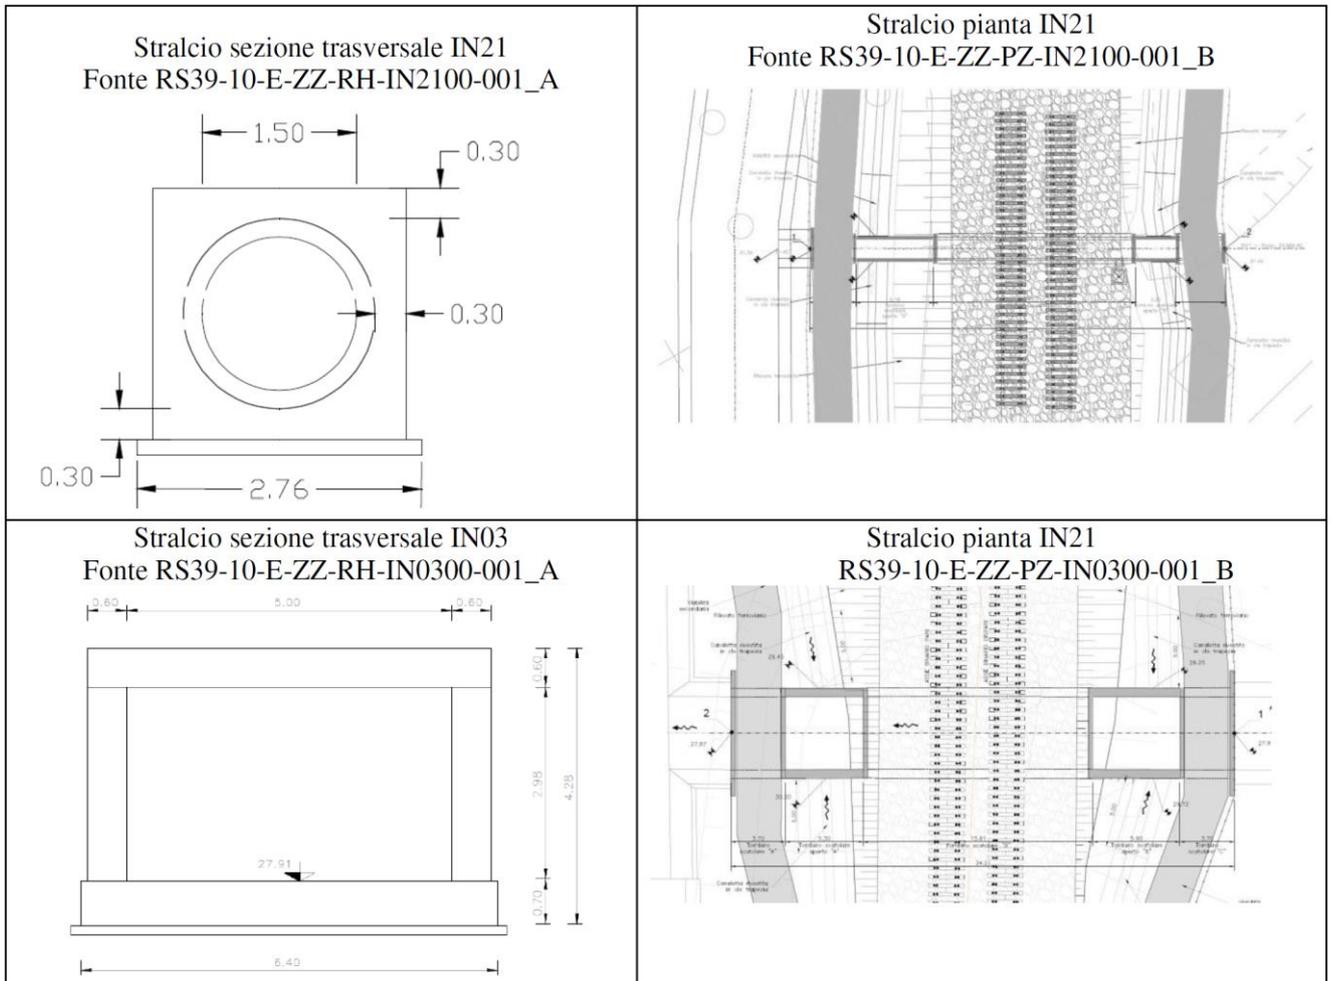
Sezioni e planimetria - attraversamenti IN21 e IN30
